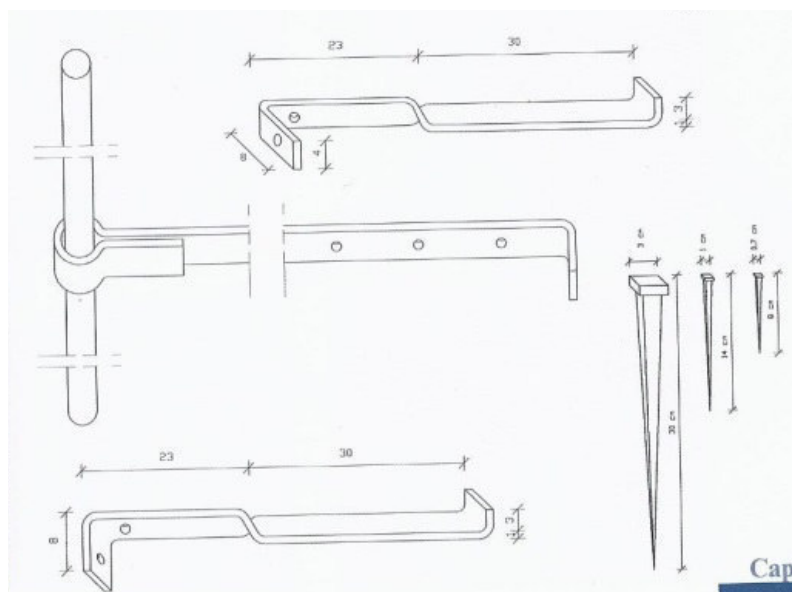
Diferentes peças metálicas de ligação pavimento/paredes
